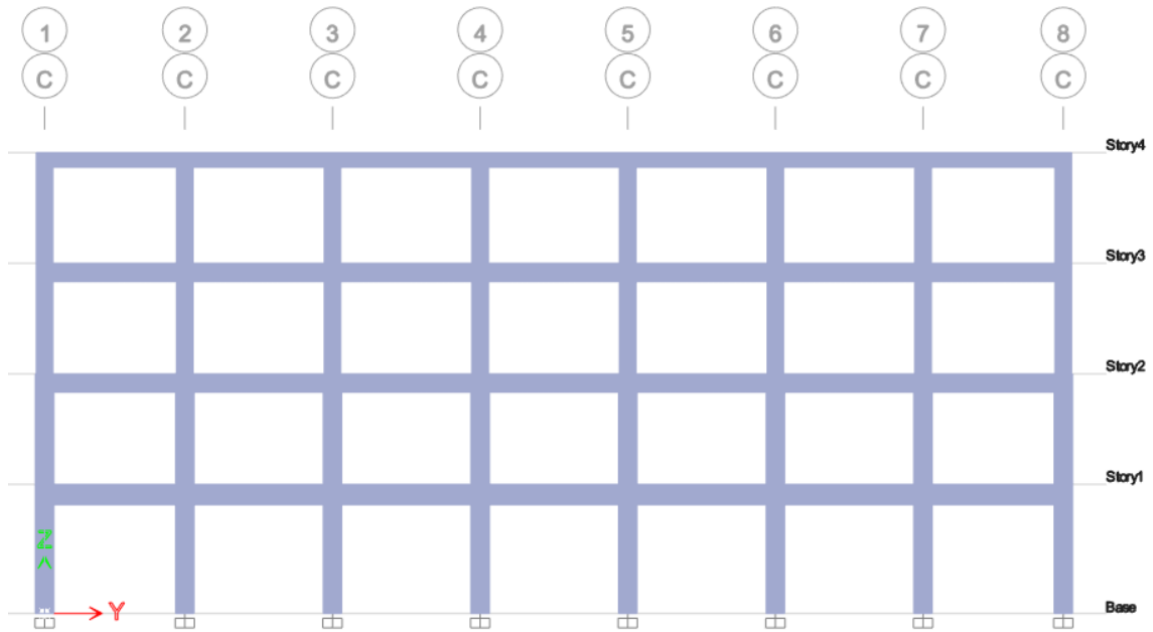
Modelado estructural de la edificación tipo (ET), alzado longitudinal (Eje C) (Autores)
